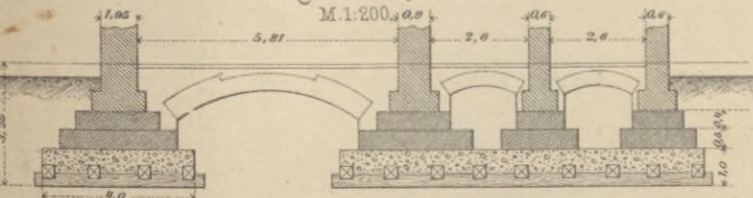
Schwellrost mit Beton und Eiseneinlage Auditorium-Gebäude in Chicago.
